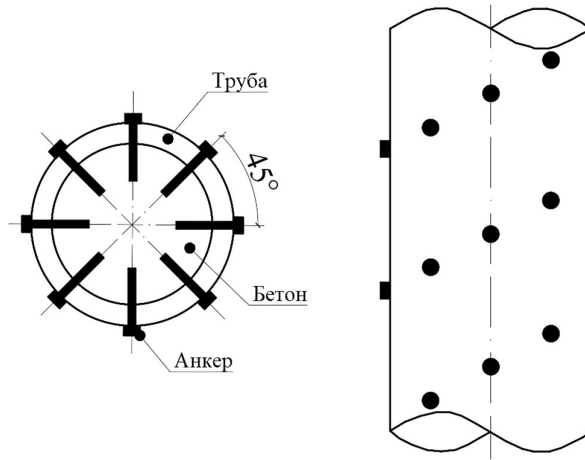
Обеспечение совместной работы трубы и бетона: анкера в трубобетонном элементе [31]
